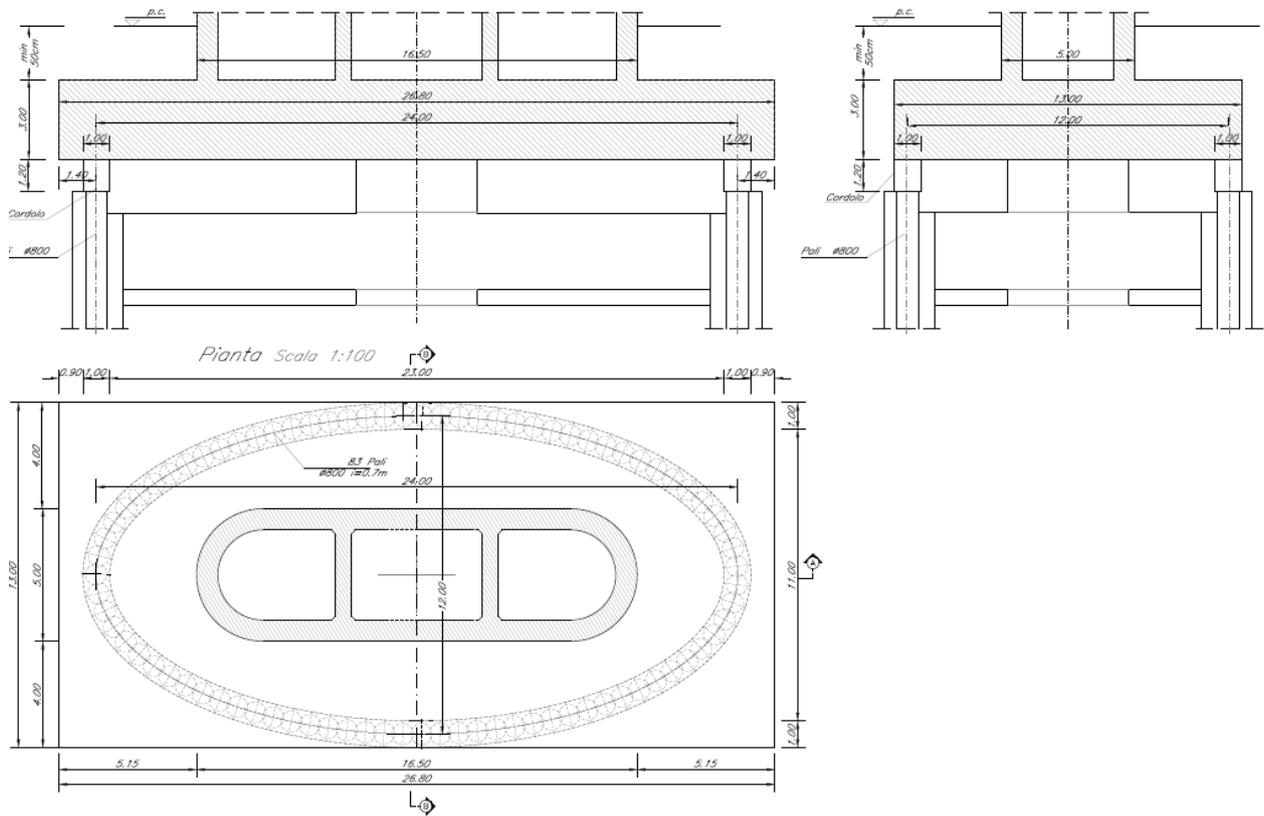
stralcio della carpenteria fondazione singolo pozzo ellittico di diametro 12x24m
